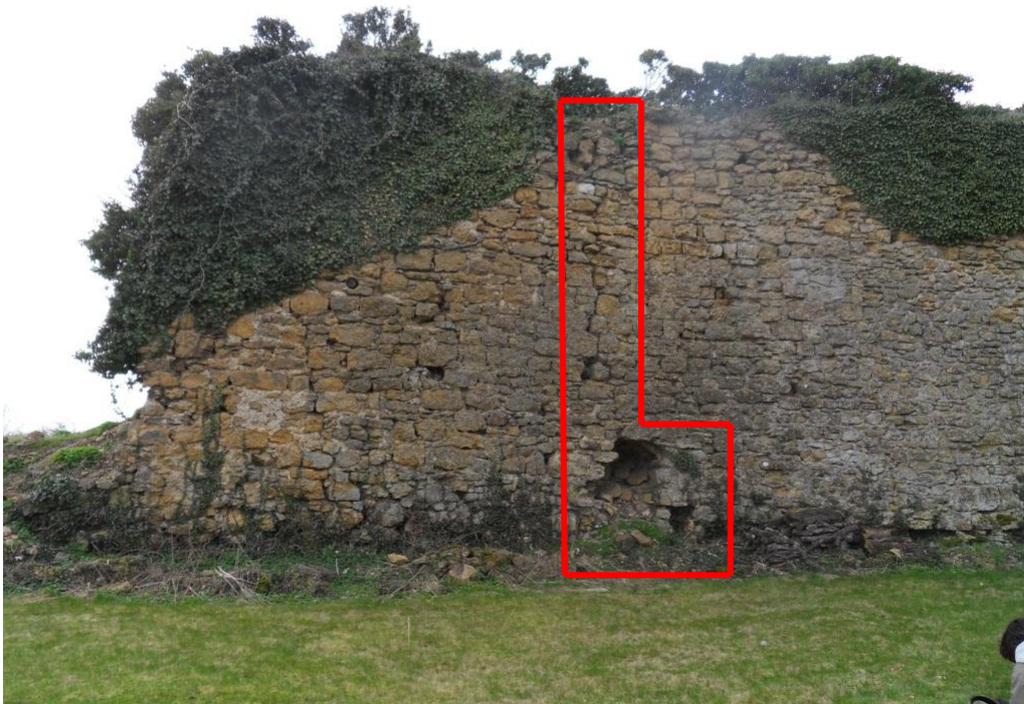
Vue sur les fissures et le sous-cavage de la section I.
